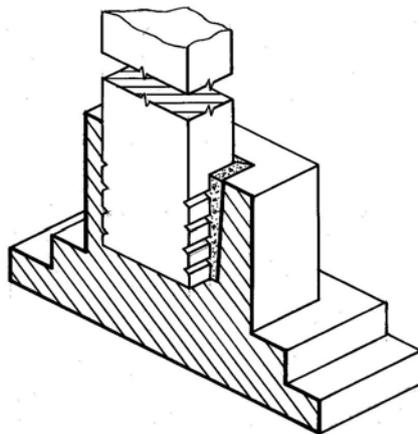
Узел сопряжения колонны с фундаментом стаканного типа
